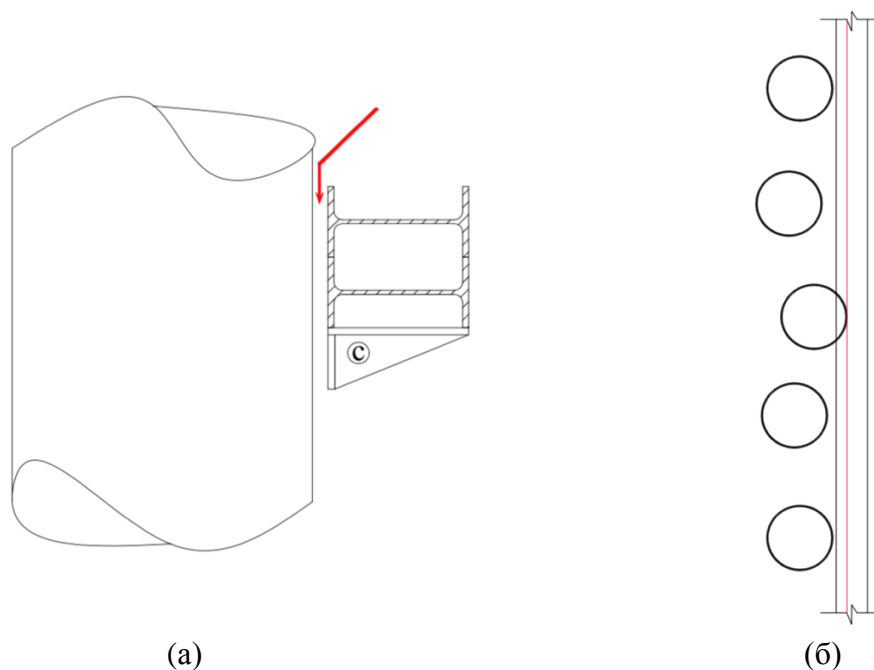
Схема распределительного пояса из сдвоенной балки: (а) вид сбоку на узел крепления опорного столика с поясом к ограждению котлована, (б) план устройства распределительного пояса.
